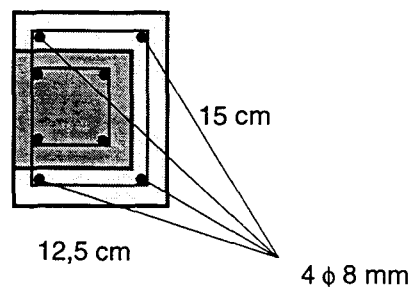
Detalhe do estribo e das armaduras longitudinais.
